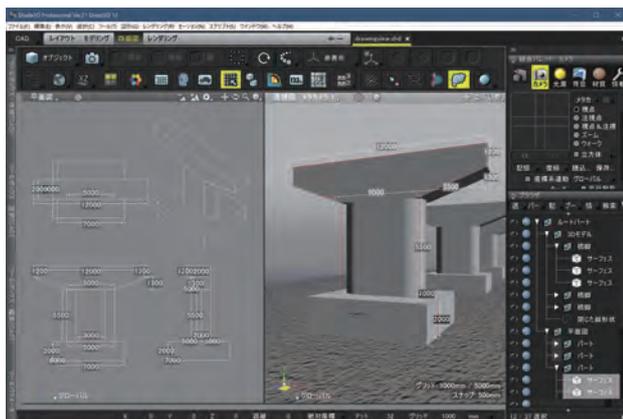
平面図表示(左)と平面図と3Dモデルの重ね合わせ(右)
